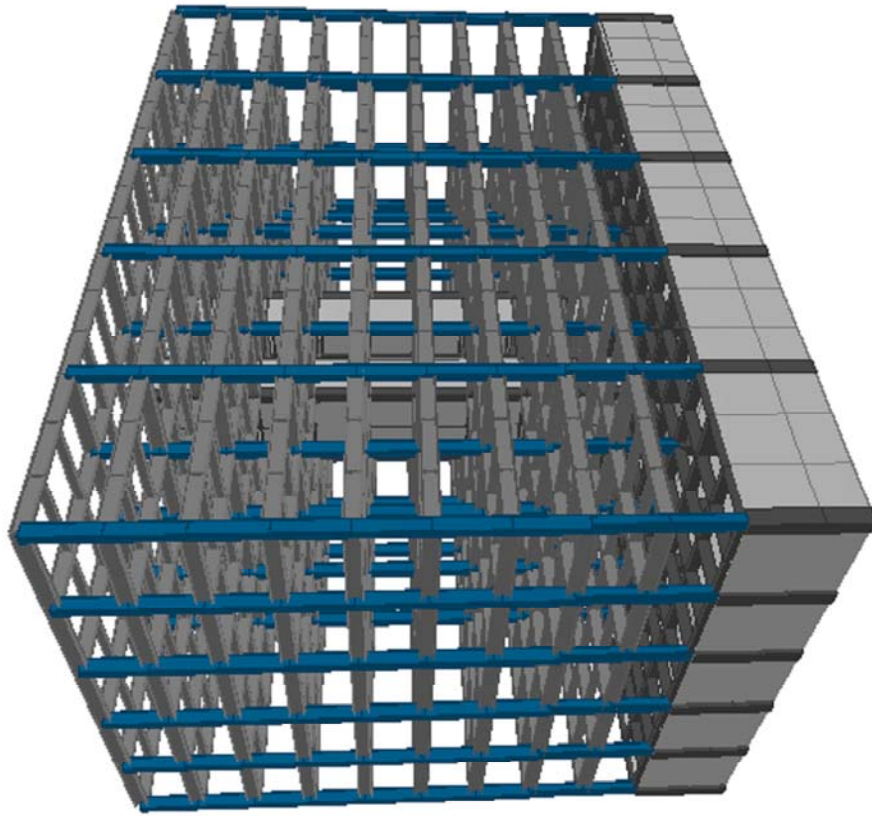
PLANTA TIPO, ESTRUCTURA DE ACERO NIVEL 1 AL NIVEL 8 MODELO B
